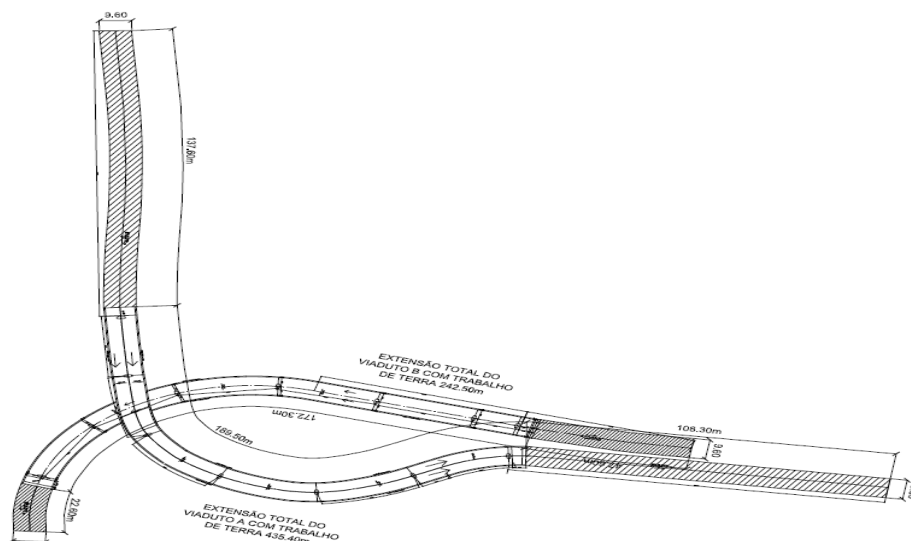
Extensões estruturais e de aterro dos viadutos A e B em planta
